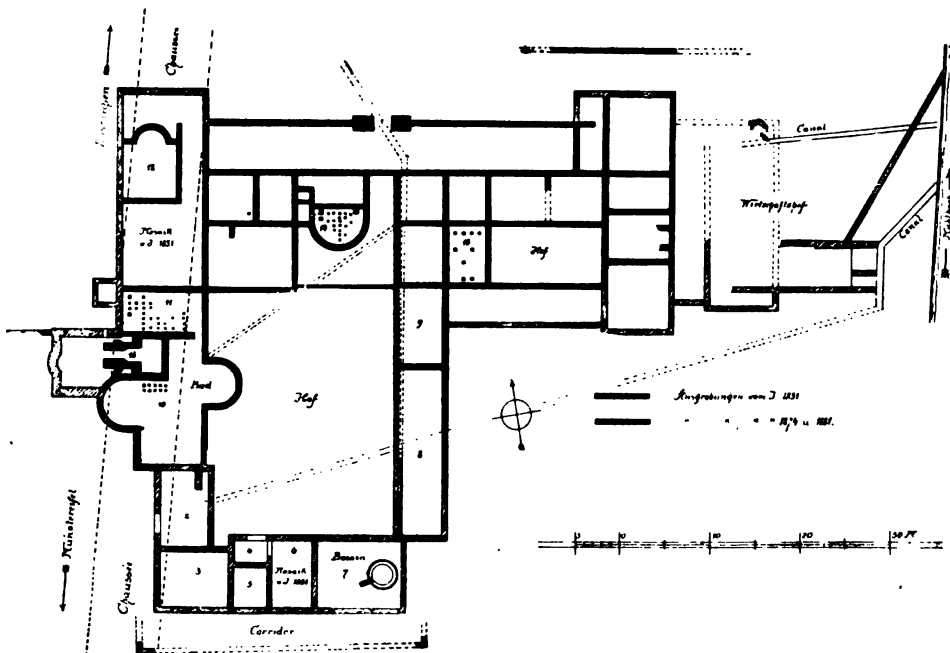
Weingarten. Grundriss der römischen Villa.
